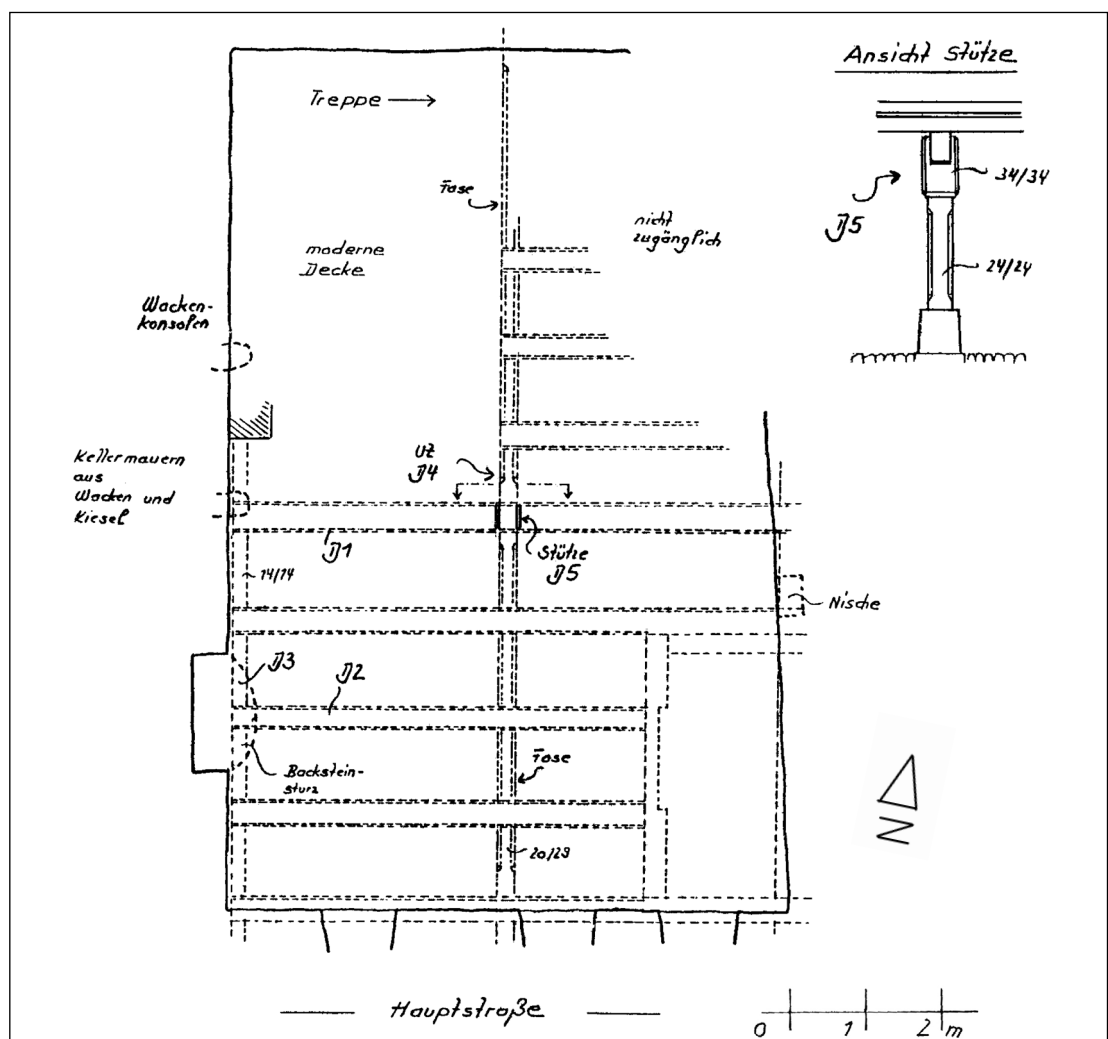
Hauptstraße 62, Grundriss Keller.
